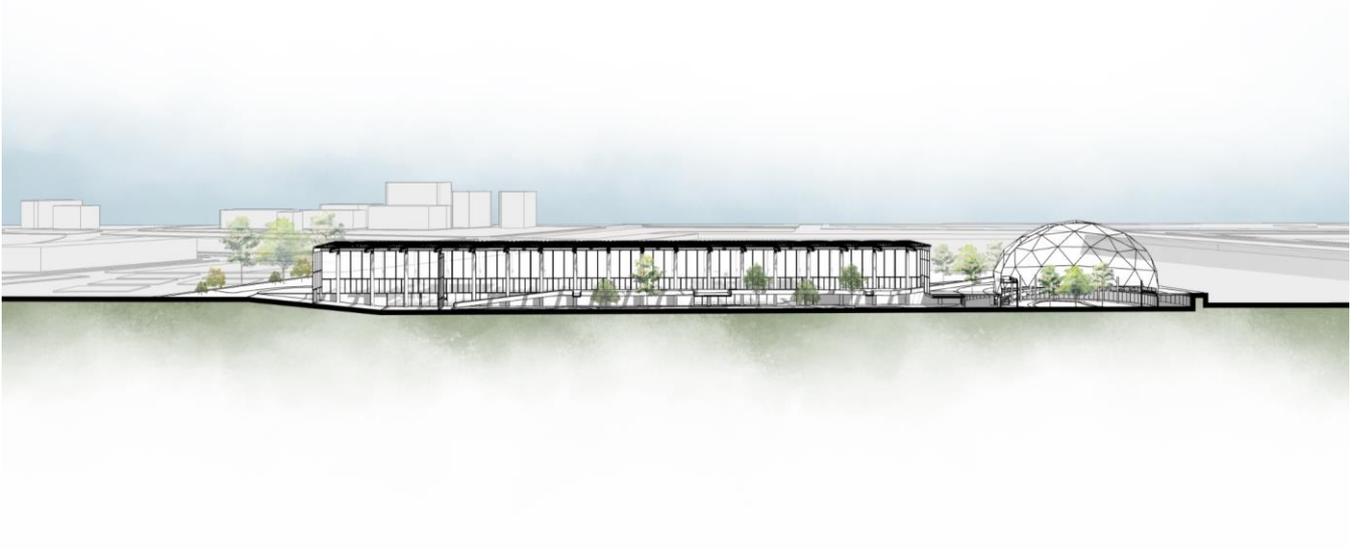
Corte longitudinal A-A'. Elaboración propia.
